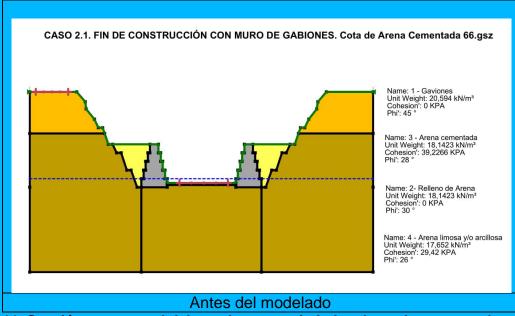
Sección transversal del canal con propiedades de suelos y muro de gaviones construido.
